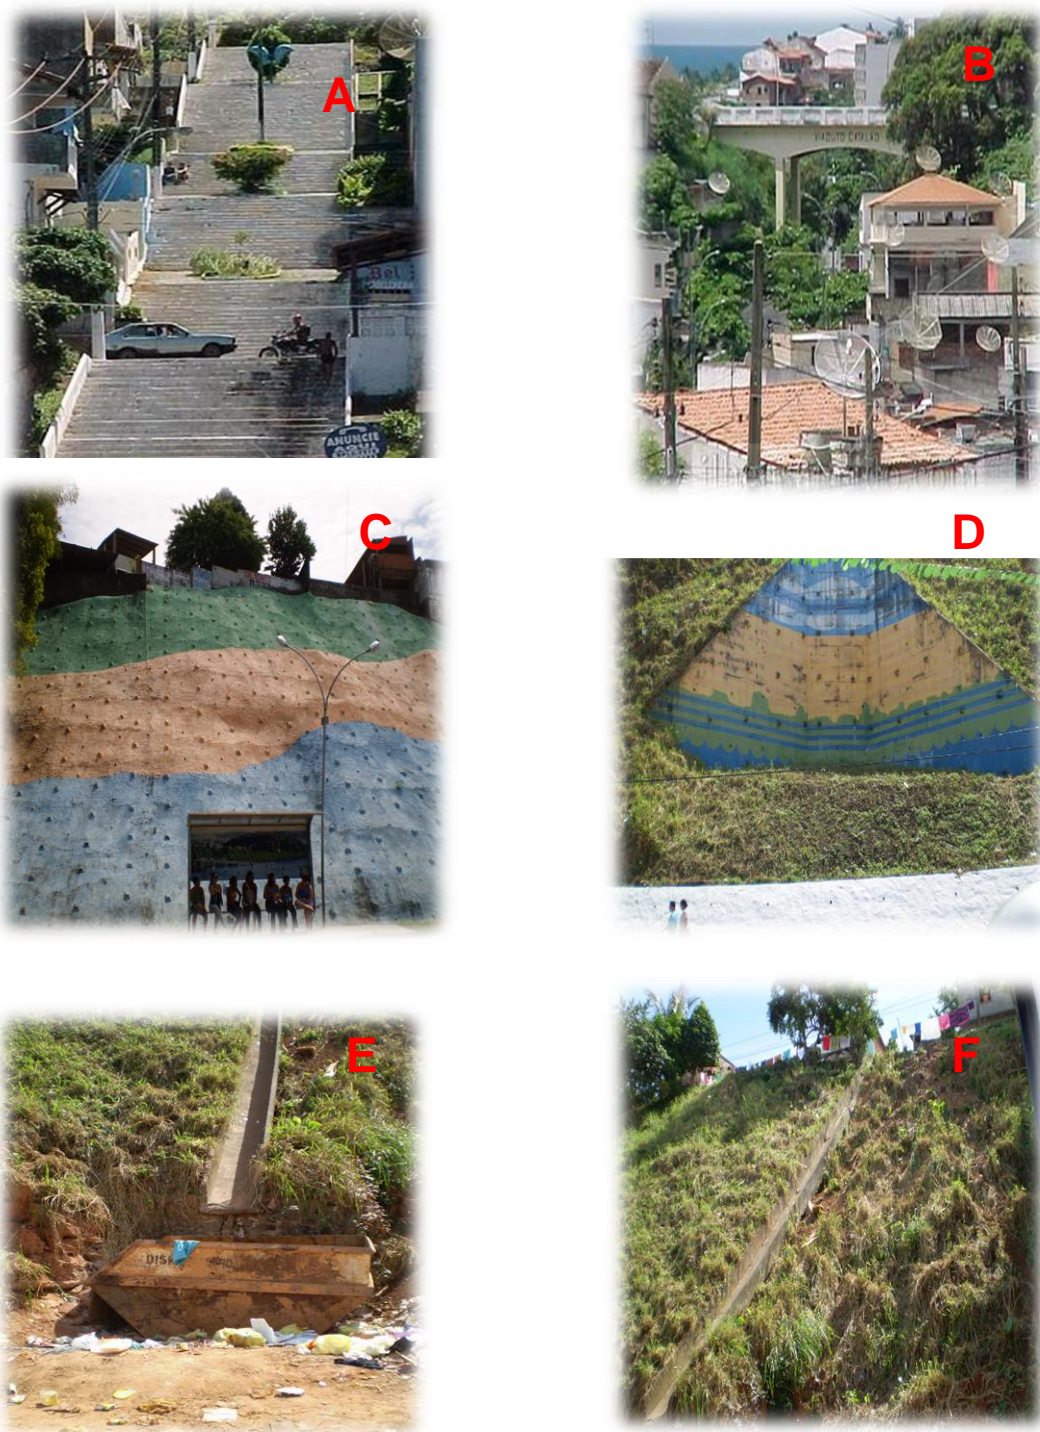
Proposições do Plano Urbano de 1933 concretizadas em anos posteriores ao plano. (A) Escadaria da Rua Sete de Setembro – Centro, (B) Viaduto Catalão, (C) Muro de arrimo da Av. Canavieiras – Centro, (D) Muro de contenção – Av. Itabuna, (E) Coleta de lixo no morro (vista da Av. Itabuna) (F) Canaleta da coleta de lixo no morro
